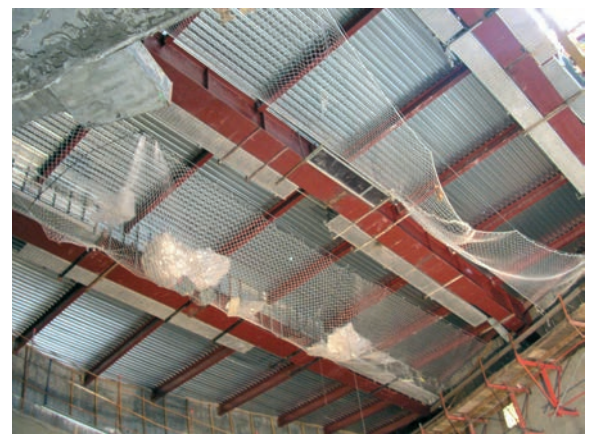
Vista de las vigas previamente al montaje y colocadas en su posición definitiva.
